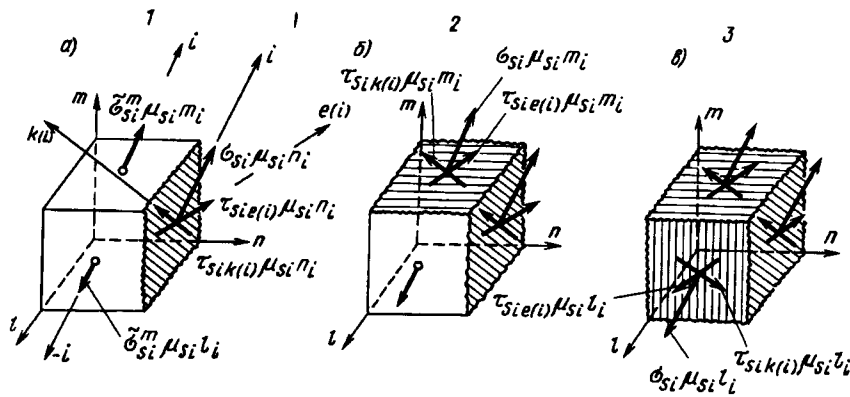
Компоненты напряжений наклонной арматуры на площадках трещин (при схемах трещин 1—3)
